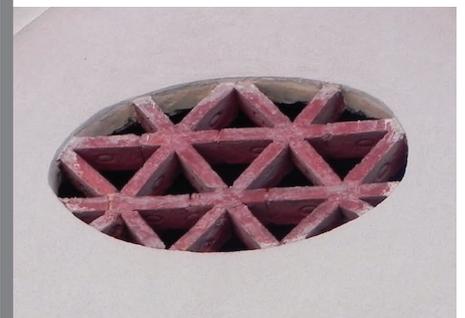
Detailansicht runde Ziegelgitteröffnung
